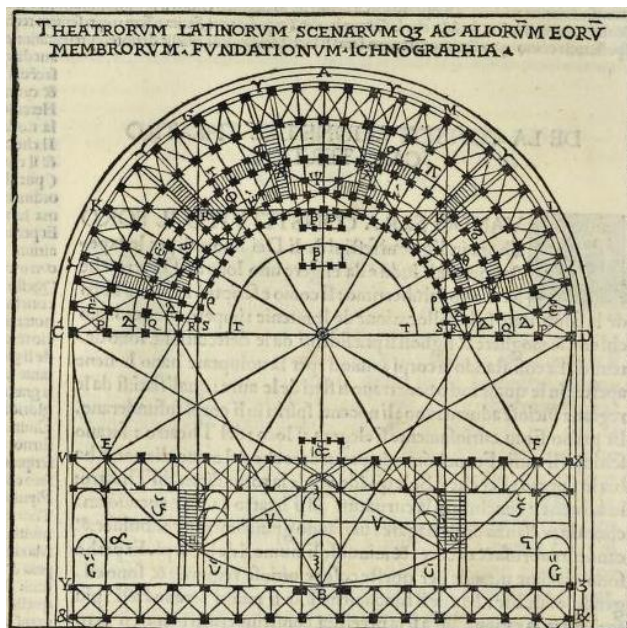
Denah Lantai Dasar Teater Yunani
